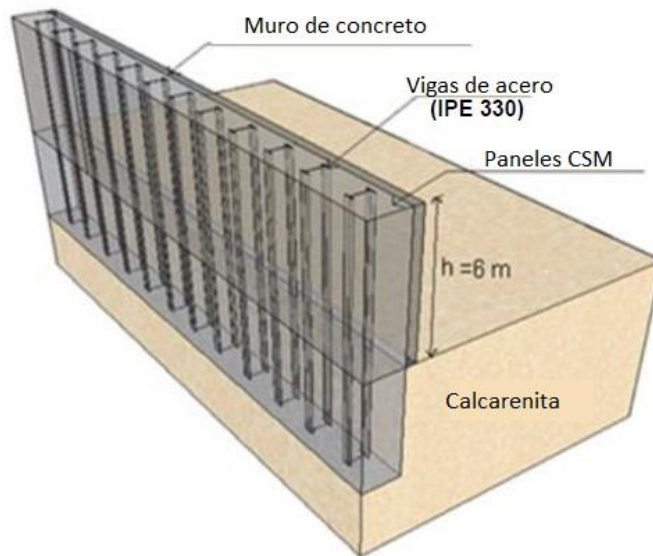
Solución estructural del muro de sostenimiento. Fuente: Peixoto et al. (2012).
